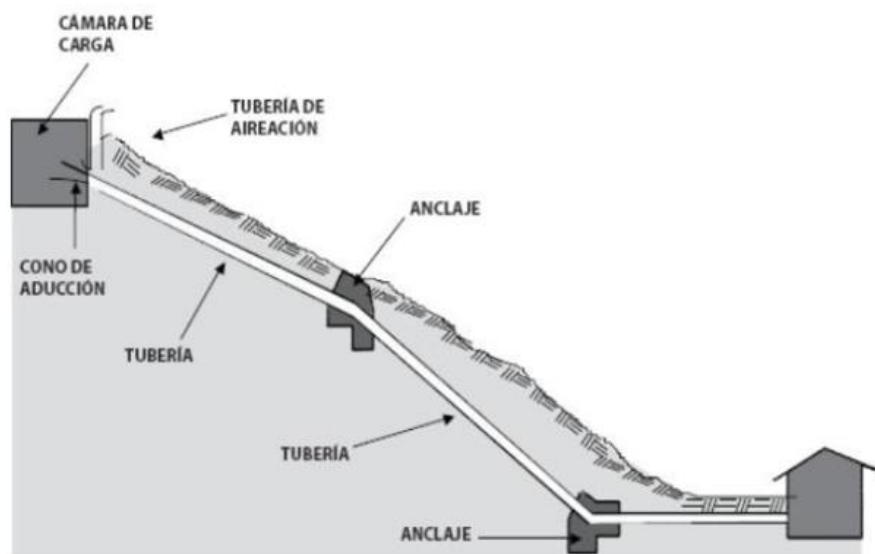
Disposición de anclajes de tubería forzada. [152]
